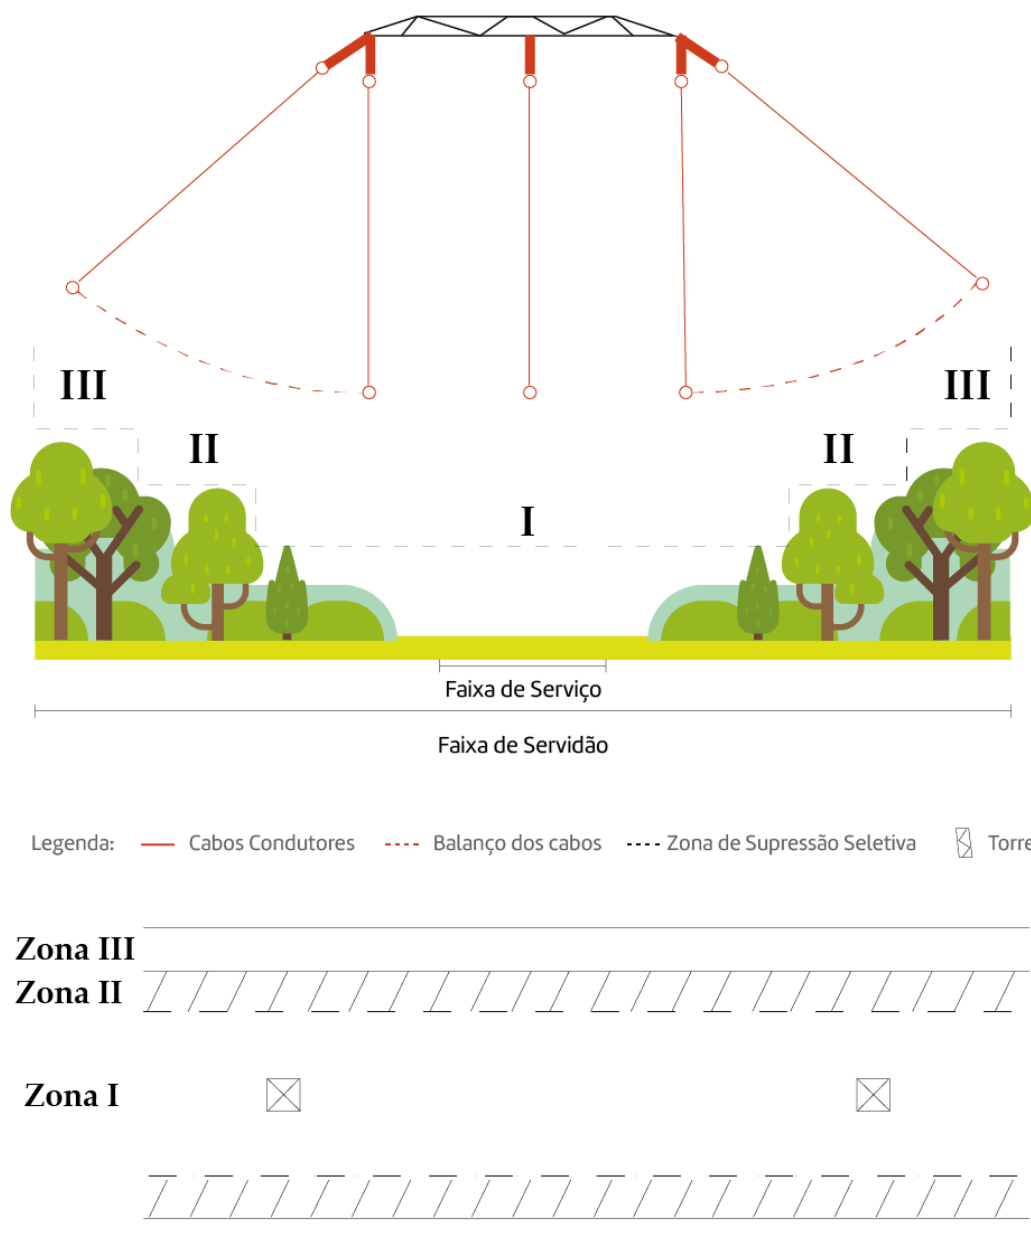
Corte transversal e planta baixa da faixa de servidão, destacando as zonas de supressão seletiva.
